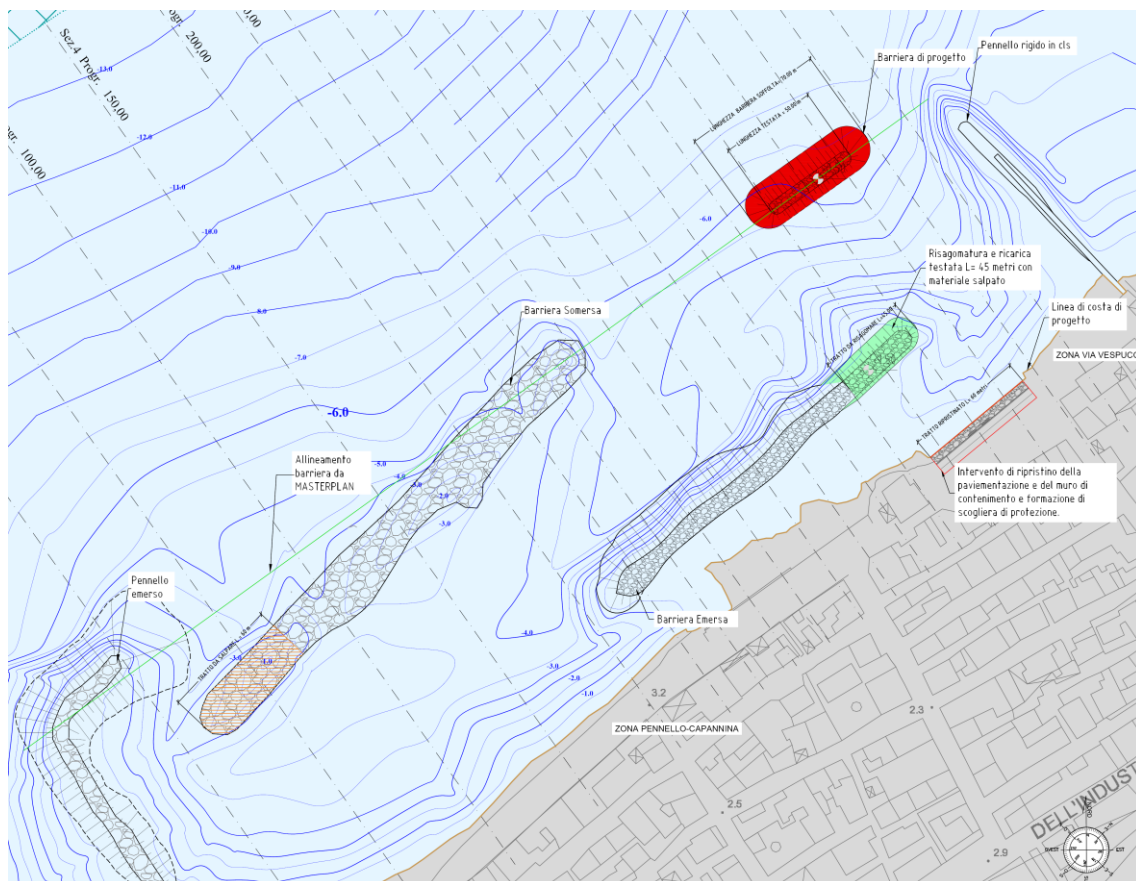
Planimetria di progetto - Realizzazione scogliera radente, salpamento, realizzazione barriera e intervento di ripristino muro e pavimentazione.
